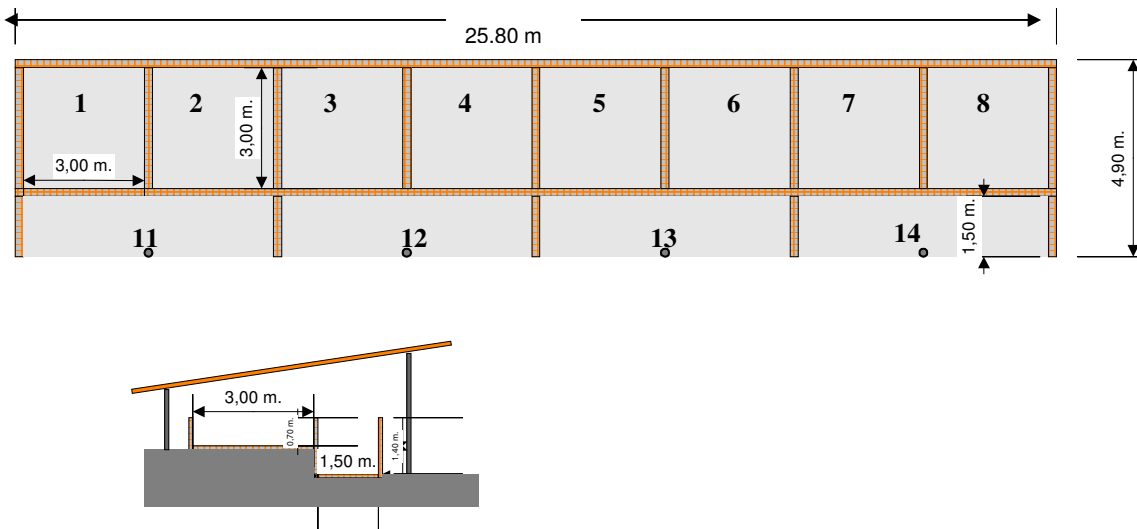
Planta baixa e corte das construções das câmaras de incorporação e compostagem.
